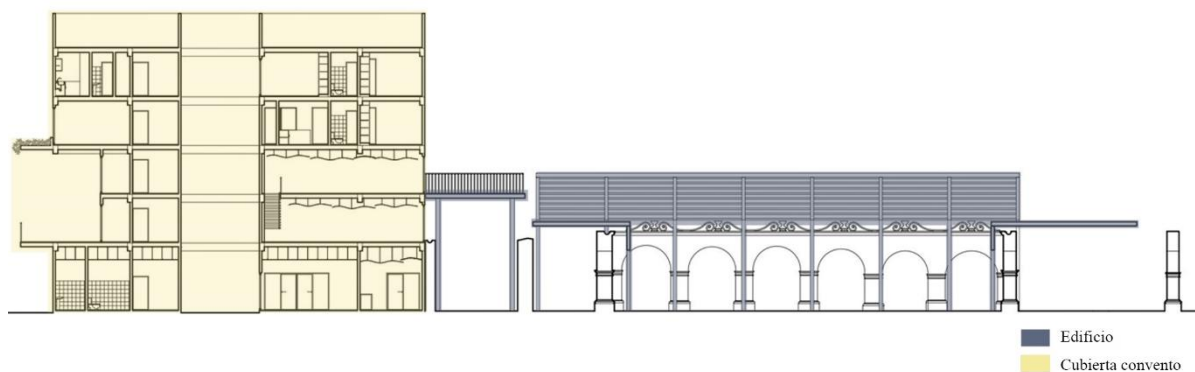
Esquema cubierta del claustro del Ex Convento. Fuente: Propia
